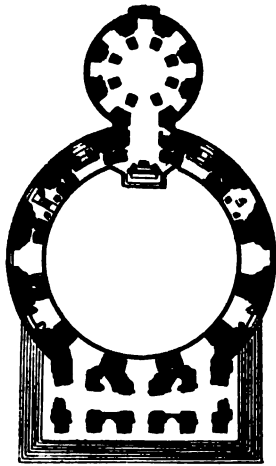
Grundriss der St. Hedwigskirche in Berlin.
